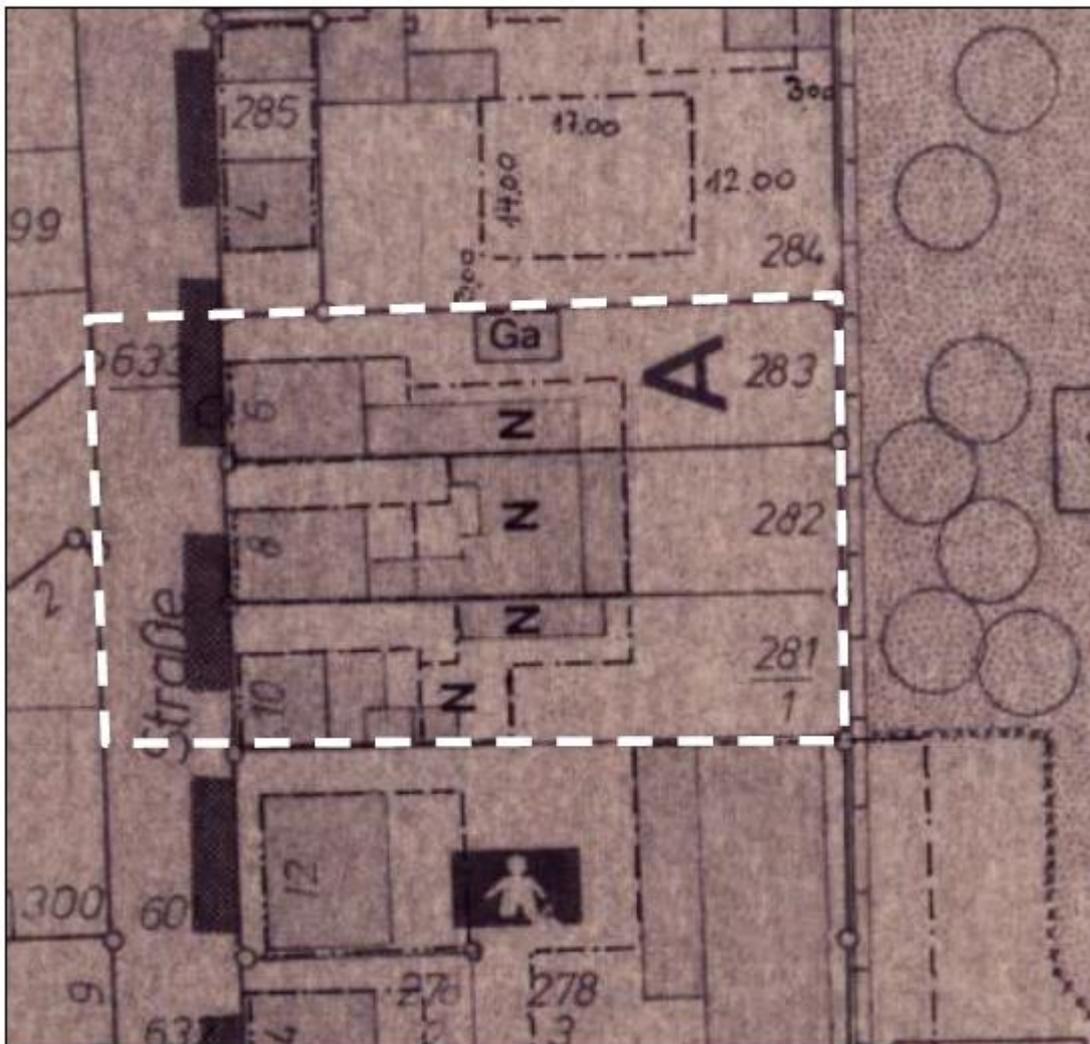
Auszug aus dem Planteil des Ursprungsbebauungsplanes
